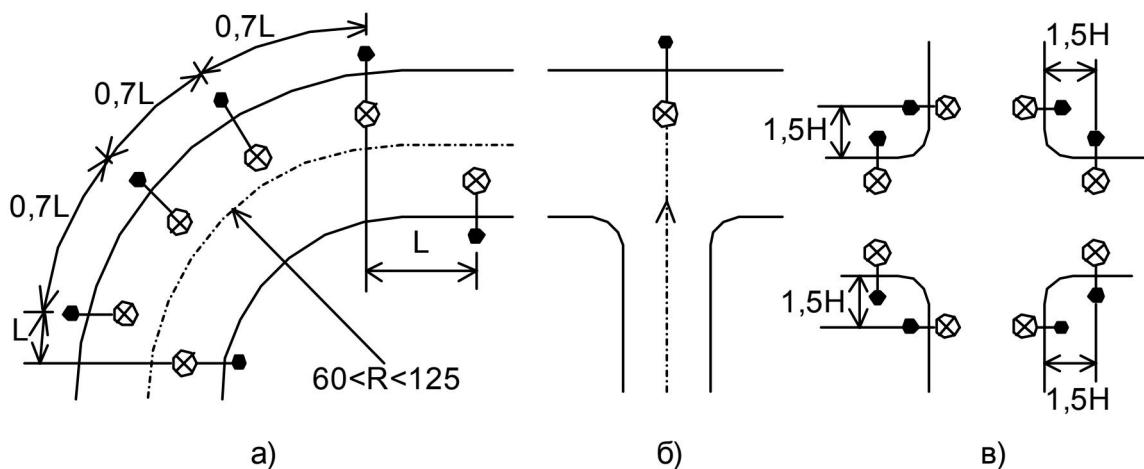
Схема расположения светильников: а – на закруглении; б – на примыкании; в – на пересечении; Н – высота установки светильников
